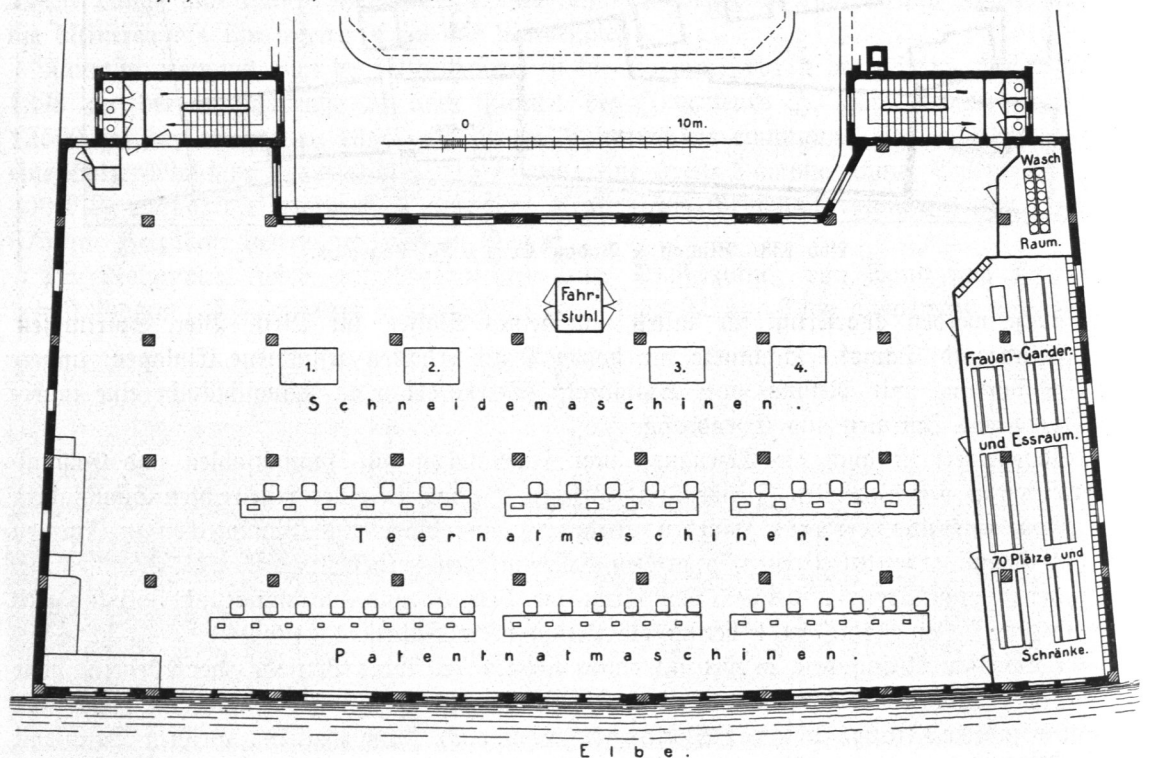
Sackfabrik von Max Bahr, Grundriß des ersten Stockes.
